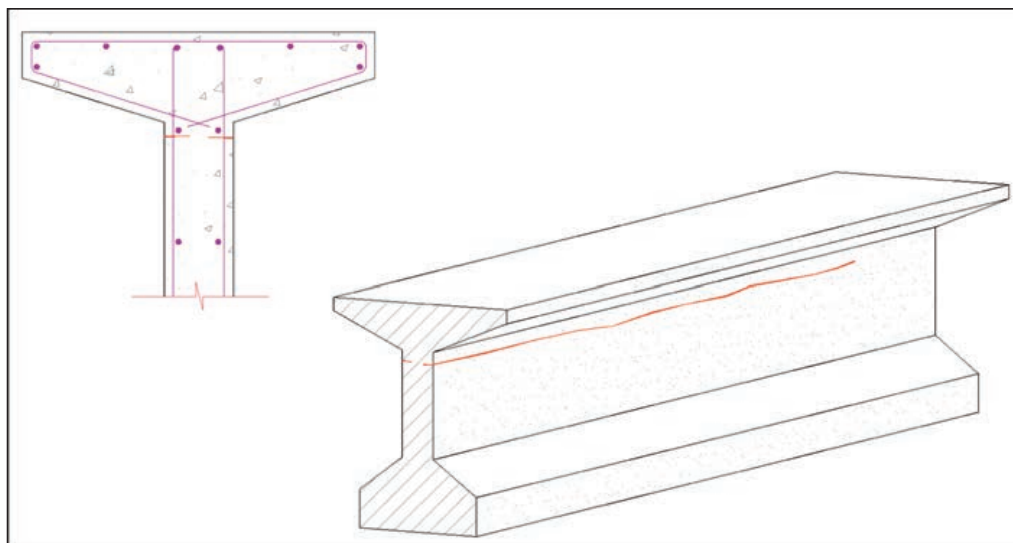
FISURAS POR ASIENTO PLÁSTICO EN VIGAS. SON FISURAS DE ANCHO APRECIABLE (0,2 A 0,5 MM) Y GENERALMENTE DE Poca PROFUNDIDAD.
